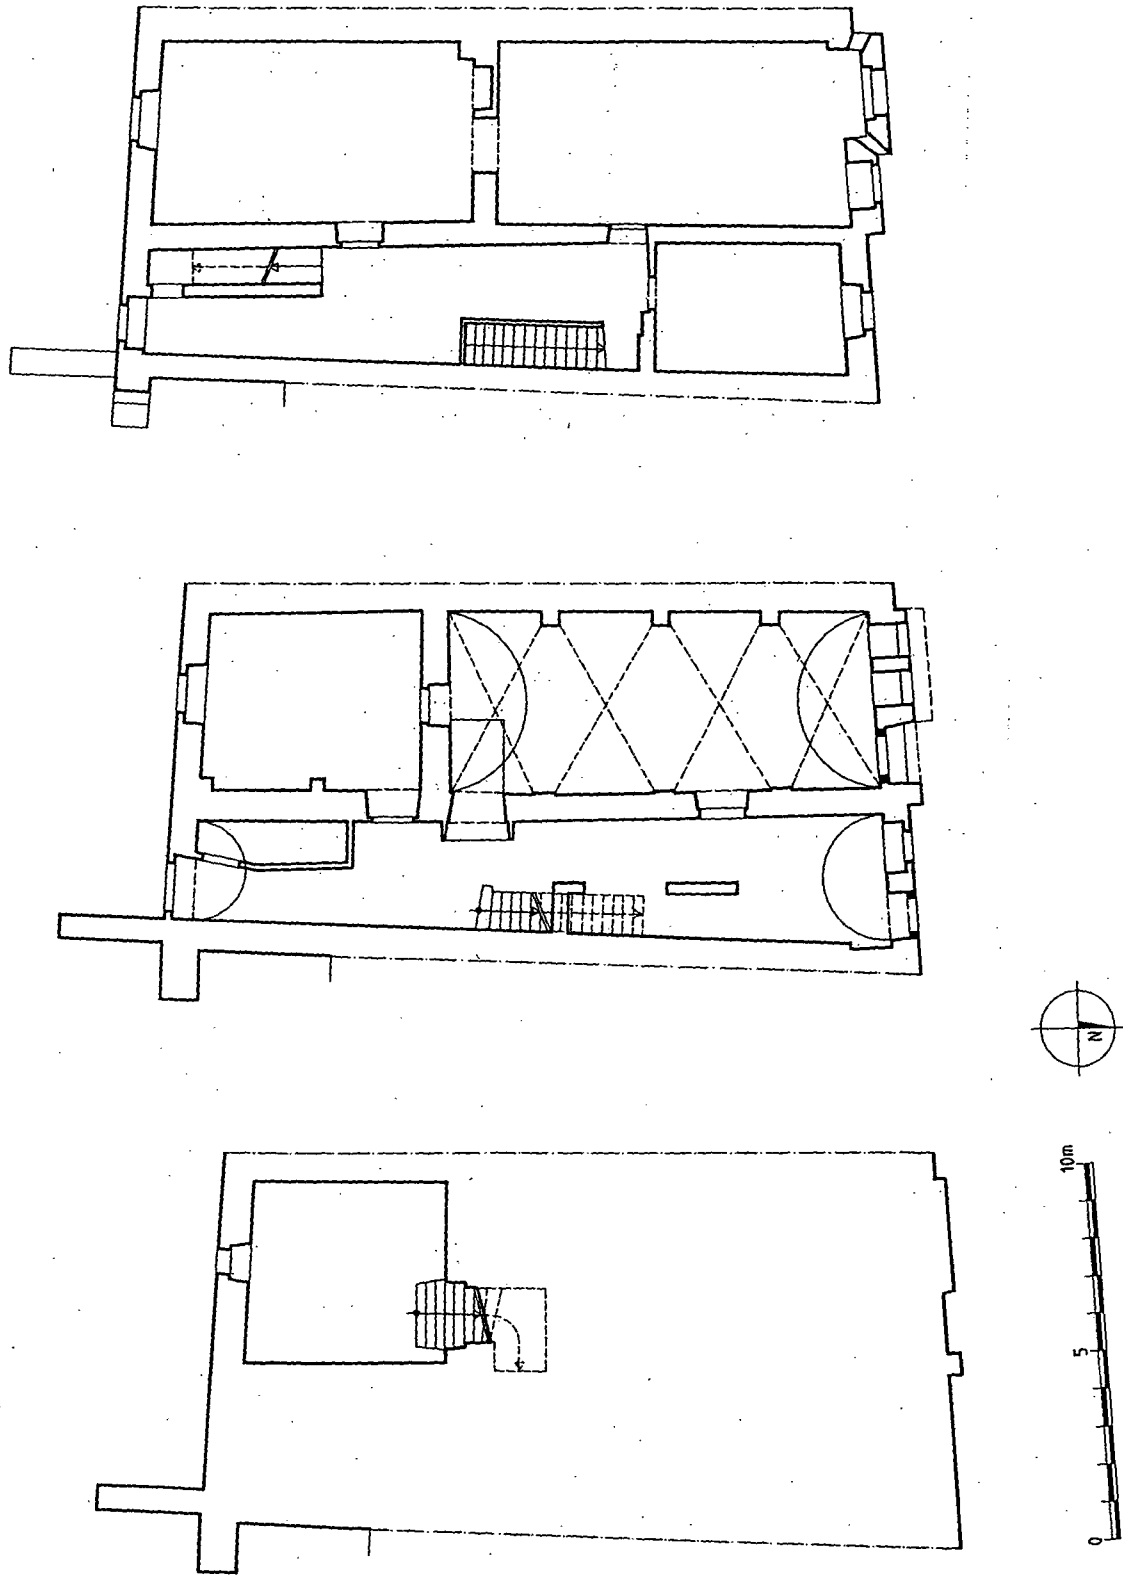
Schmiedstraße 5 – Grundrisse Keller, Erdgeschoss, Obergeschoss (1:200).
